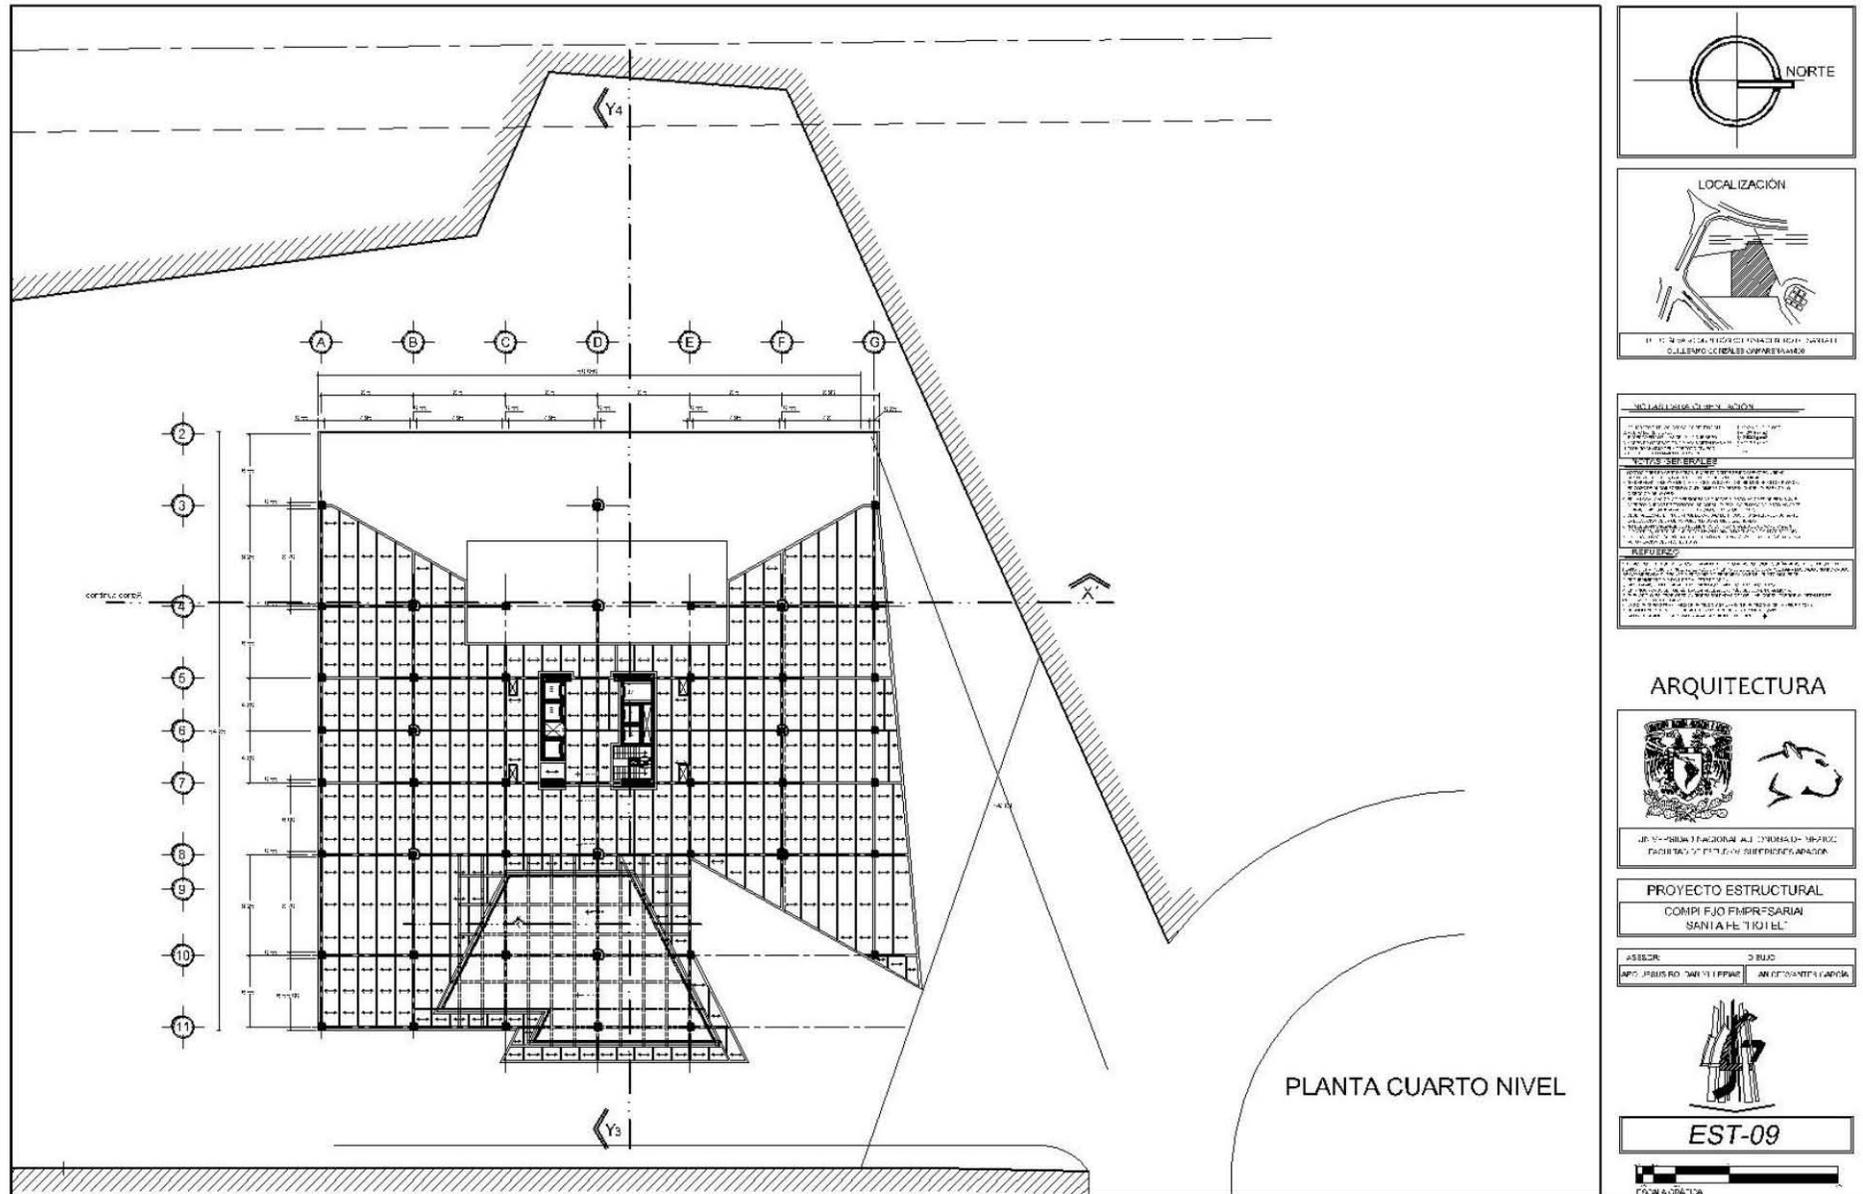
Plano Est-09; Disposición de losacero en cuarto nivel área de alberca. Edición propia.
